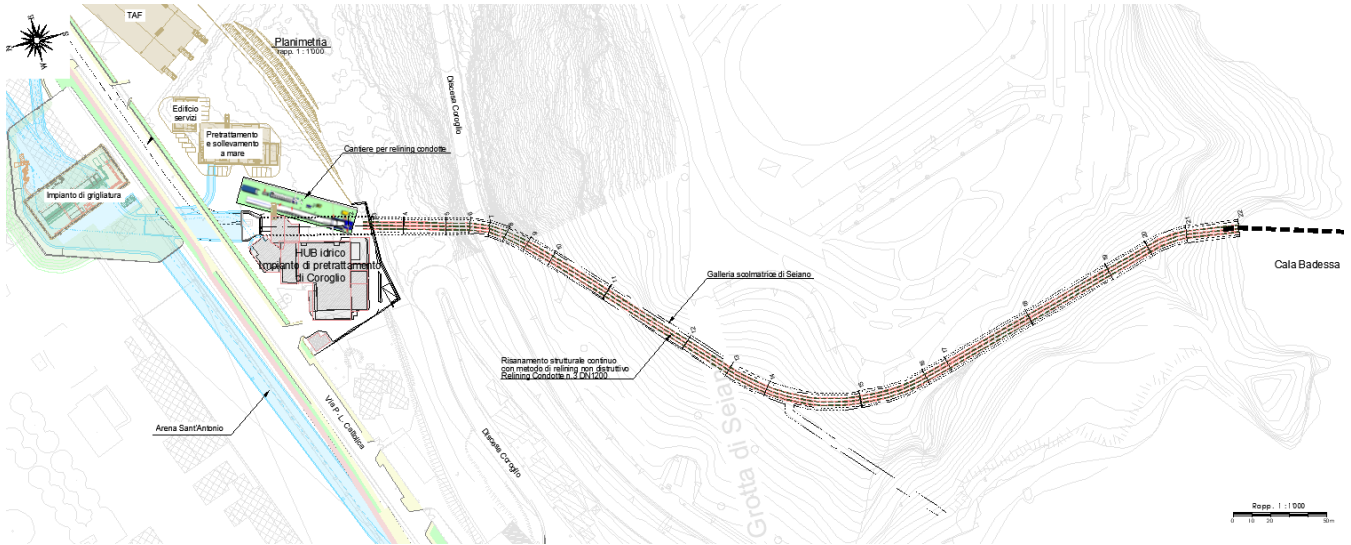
Ubicazione del cantiere principale per il relining delle tre condotte in galleria
